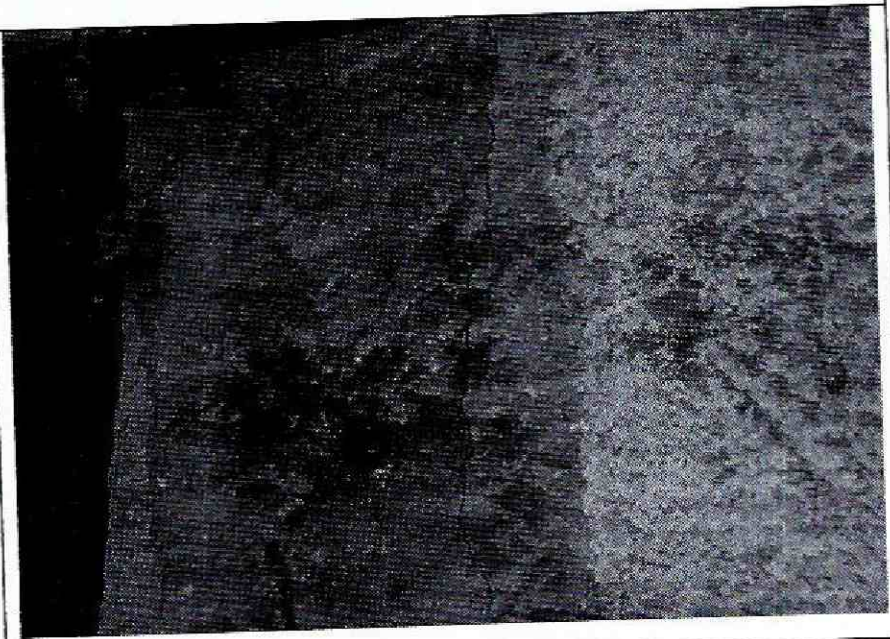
Agrietamientos en el extremo sur del muro de cerramiento.
